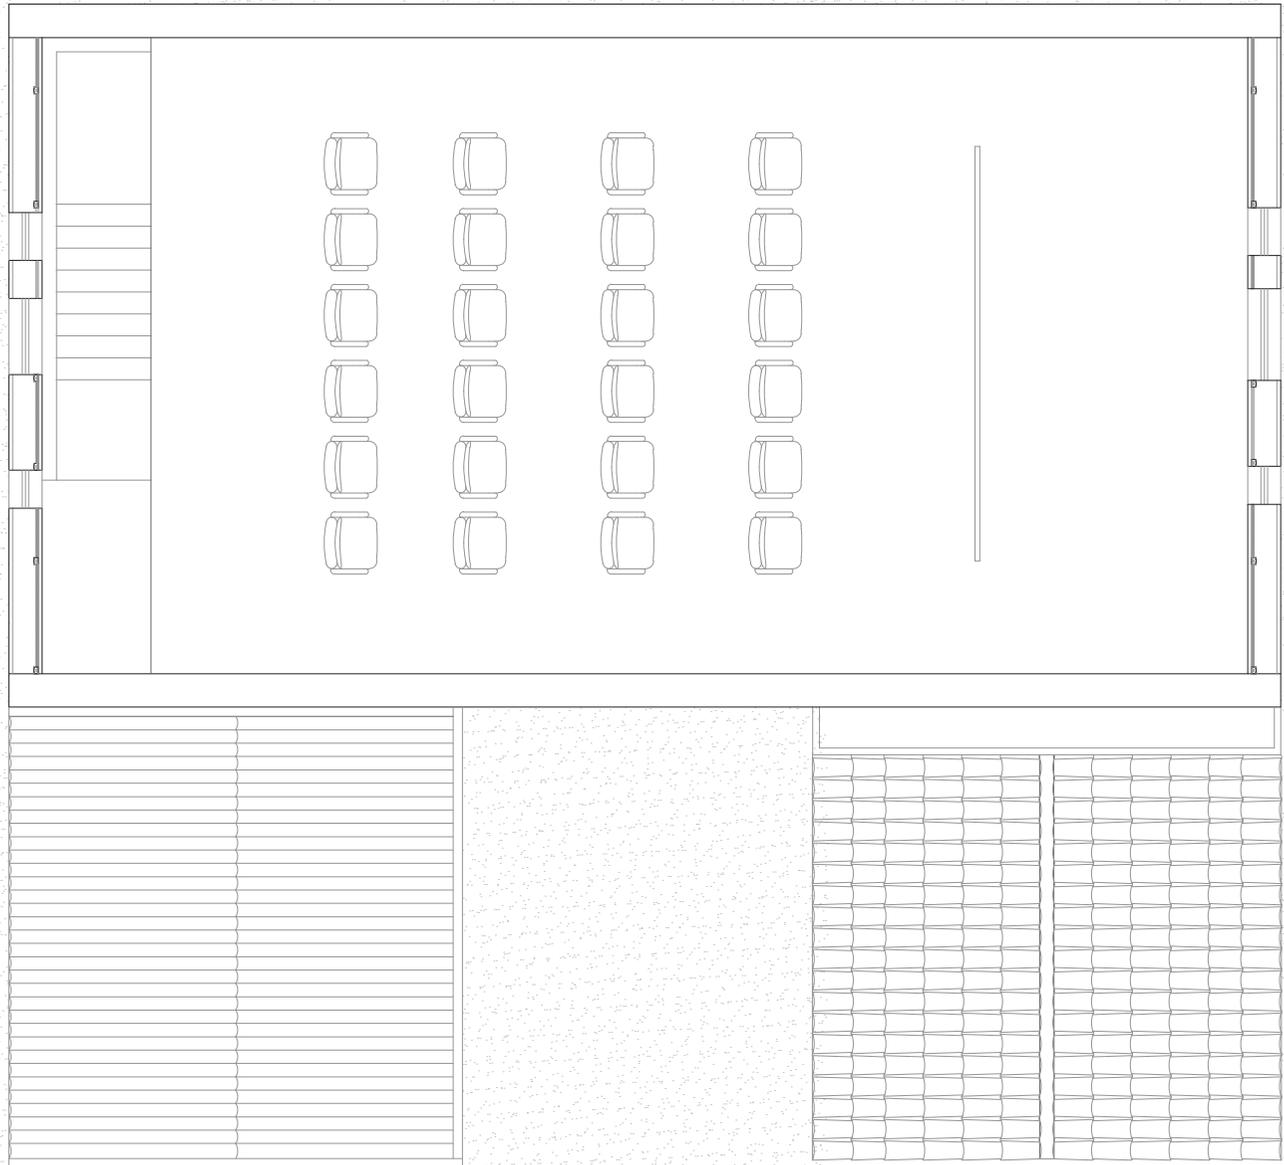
Planta primera proyecto. Escala 1/75. Fuente : Carlos Fuster Aparisi
